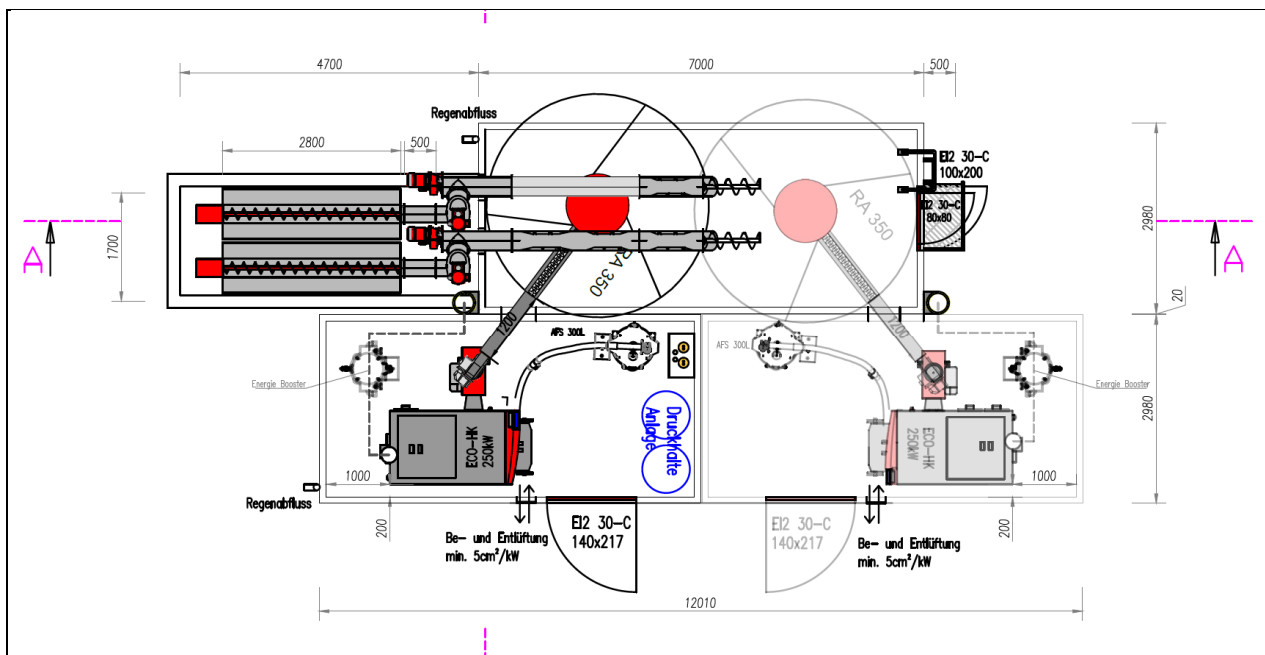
Grundriss (Prinzipdarstellung Firma Hargassner).
